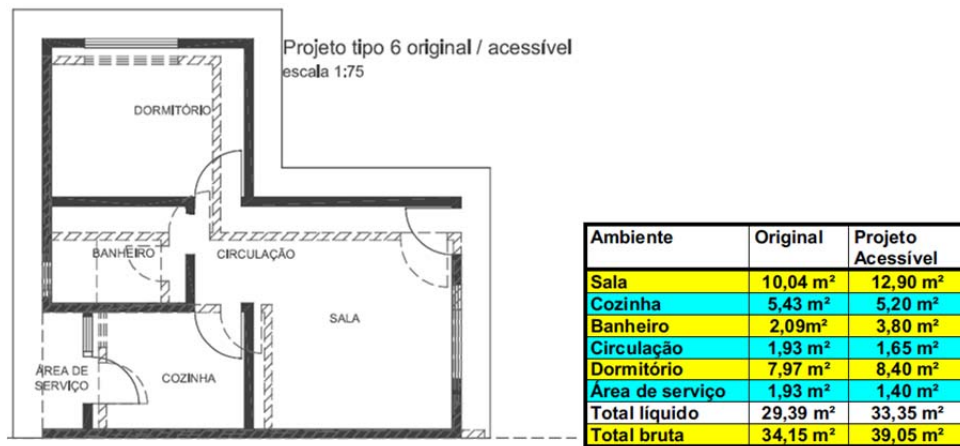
Planta baixa 6A com indicação de paredes a serem demolidas / demarcação de projeto modificado.
